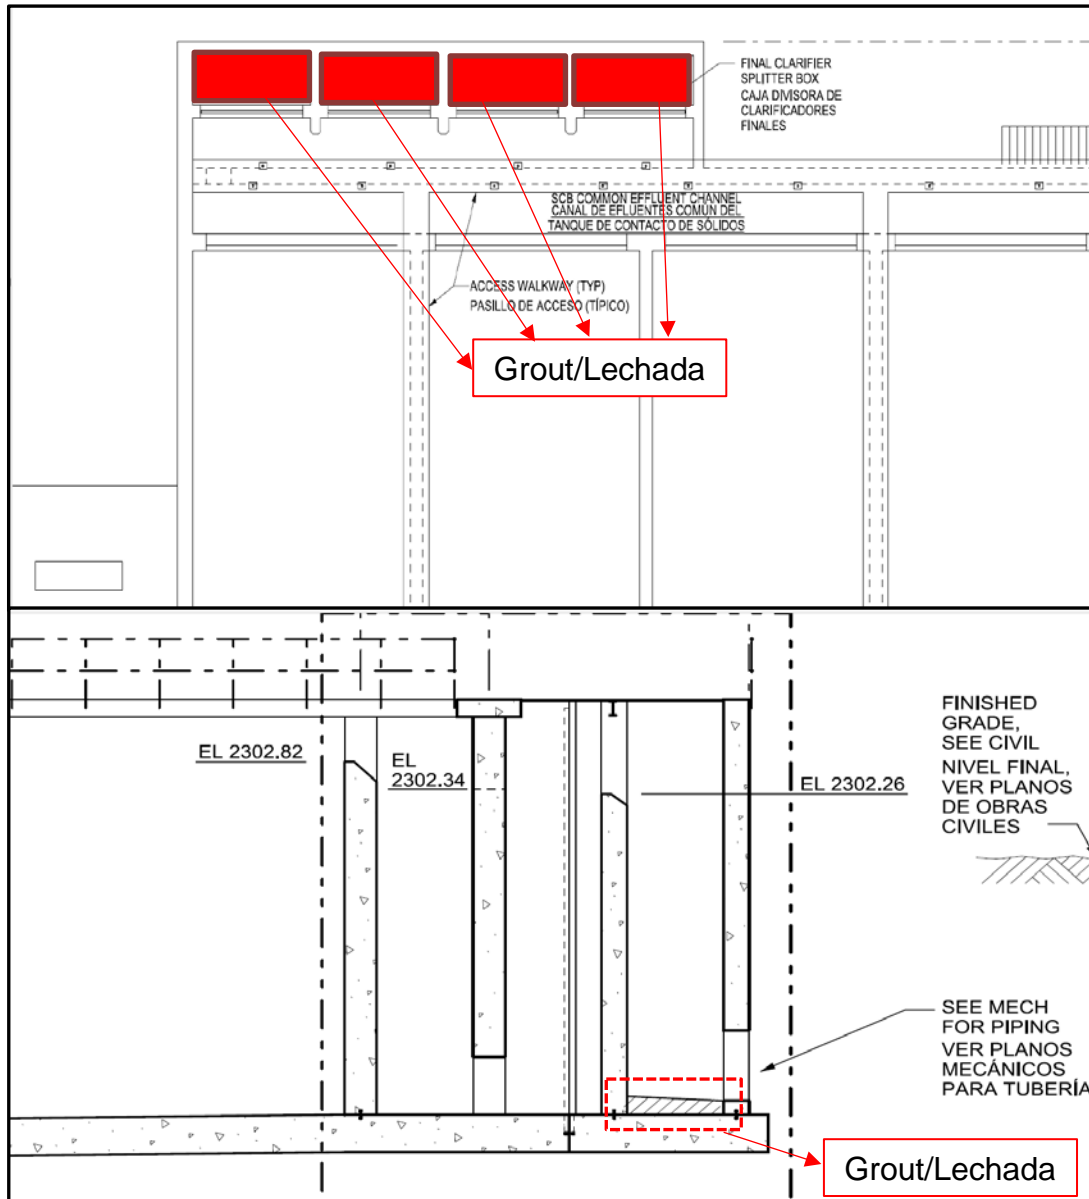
Detalles de los Estándares para el Soporte de Tubería (Grout)
